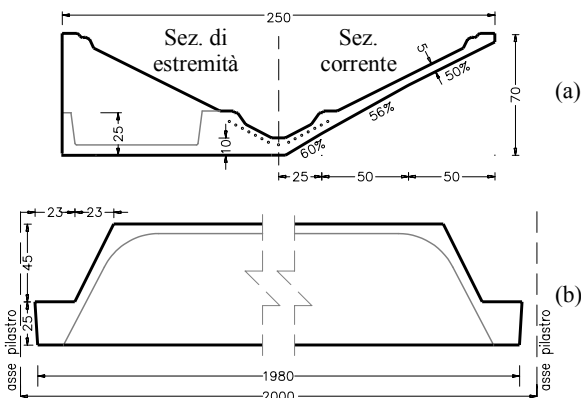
a) Semi-sezione trasversale corrente e di estremità; b) prospetto laterale
